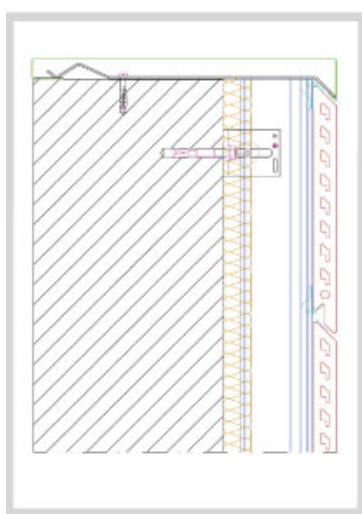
Aplicação da fachada ventilada – Remate de topo [47]
